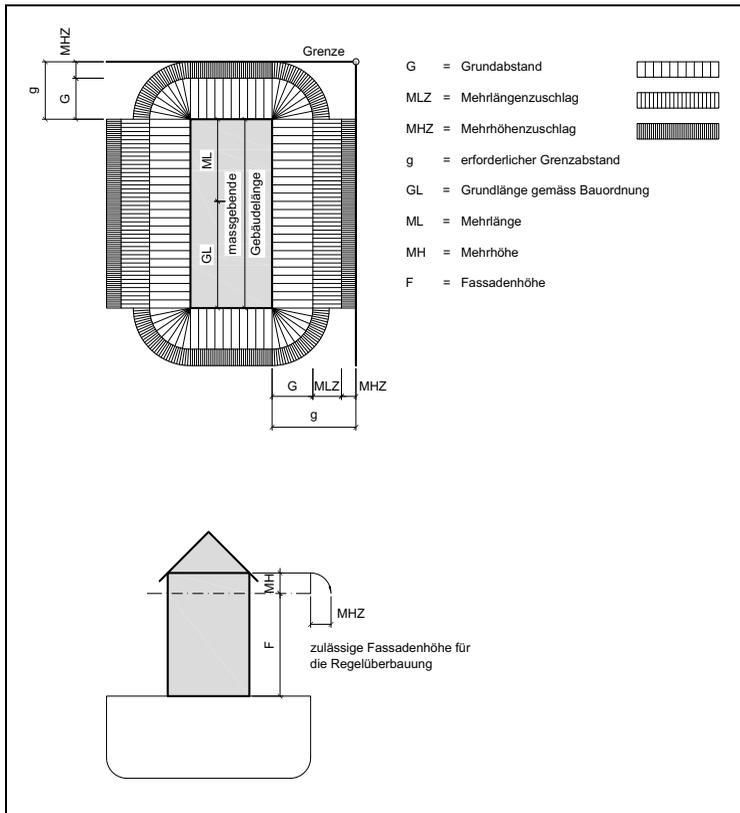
Bebaubarer Bereich und Baubereich (§ 7 ABV)
